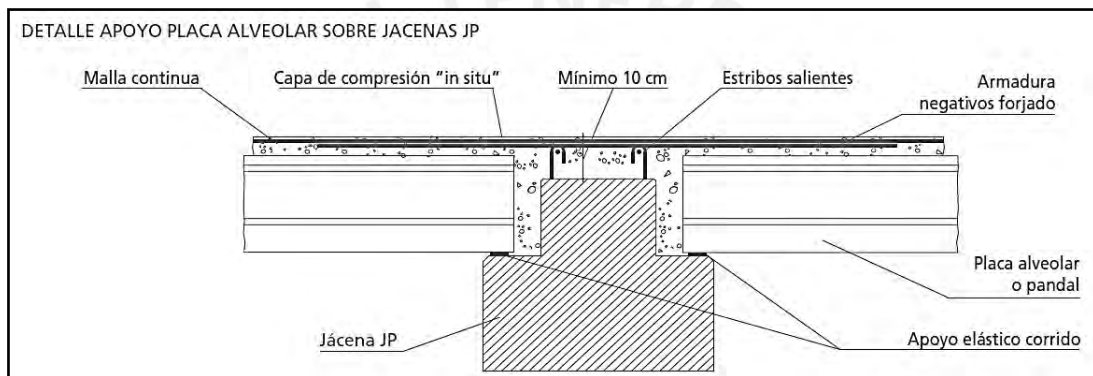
Detalle de apoyo Placa alveolar sobre Jácenas JP y capa de compresión in situ (Iberian Precast)
